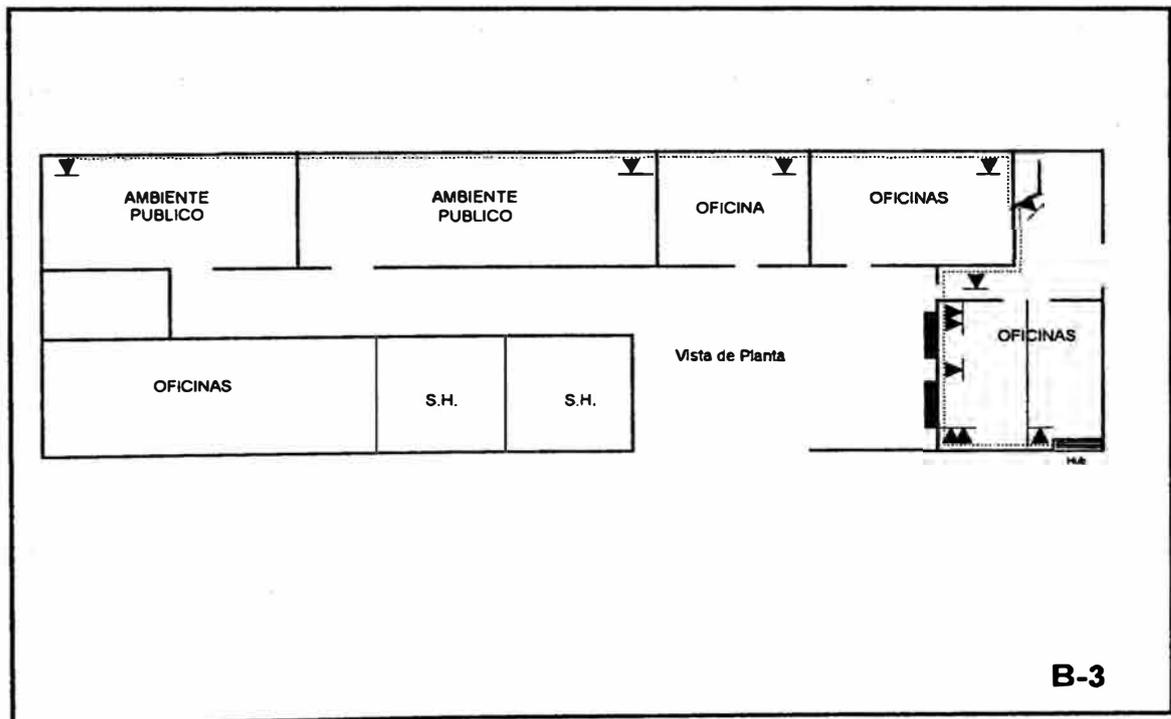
PLANO FISICO DE CONEXIONES DEL 3ER PISO - PABELLON B
